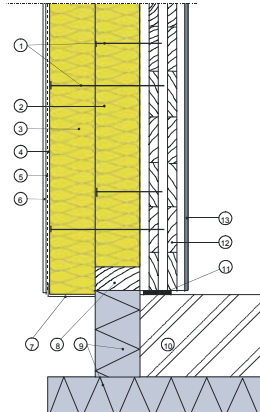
Wandaufbau (Schnitt: Außenwand, Eckanschluß)
